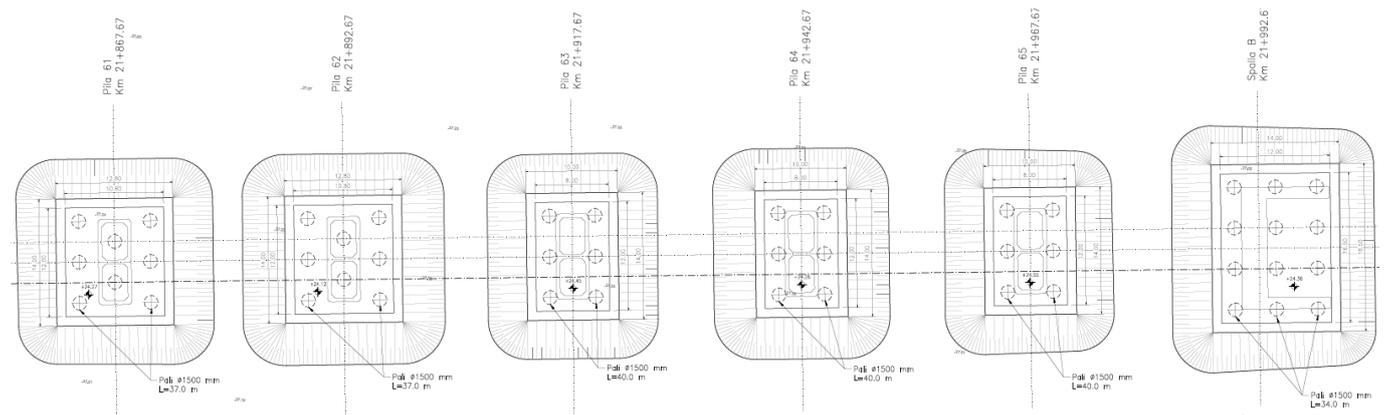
Pianta opere provvisori da pila P61 a spalla B
